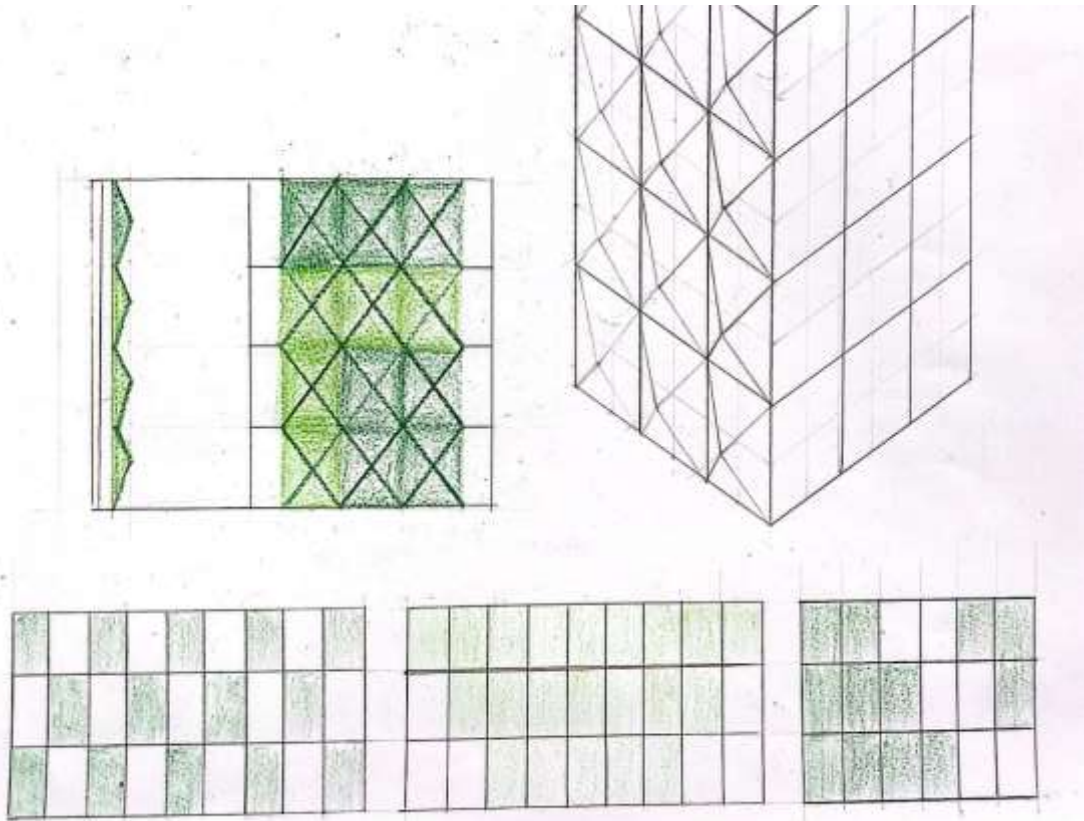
Boceto de fachada modular con figuras piramidales. Fuente: Elaboración propia
